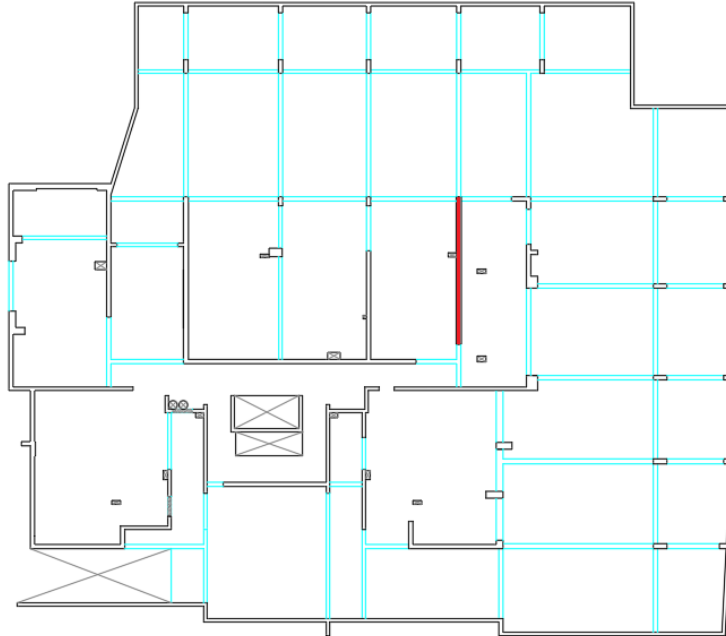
Ubicación del muro estructural dañado en el subterráneo -1.
